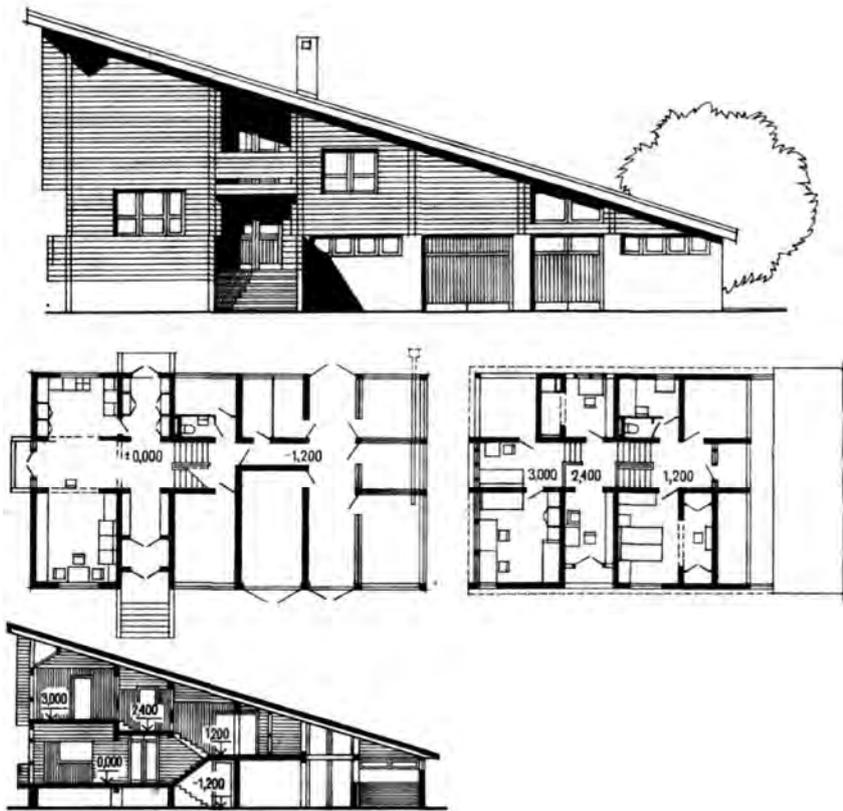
Одноквартирный брусчатый дом для северных районов РФ (конкурсный проект архит. М. Гаврилова). Фасад, план второго этажа (слева), план первого этажа
